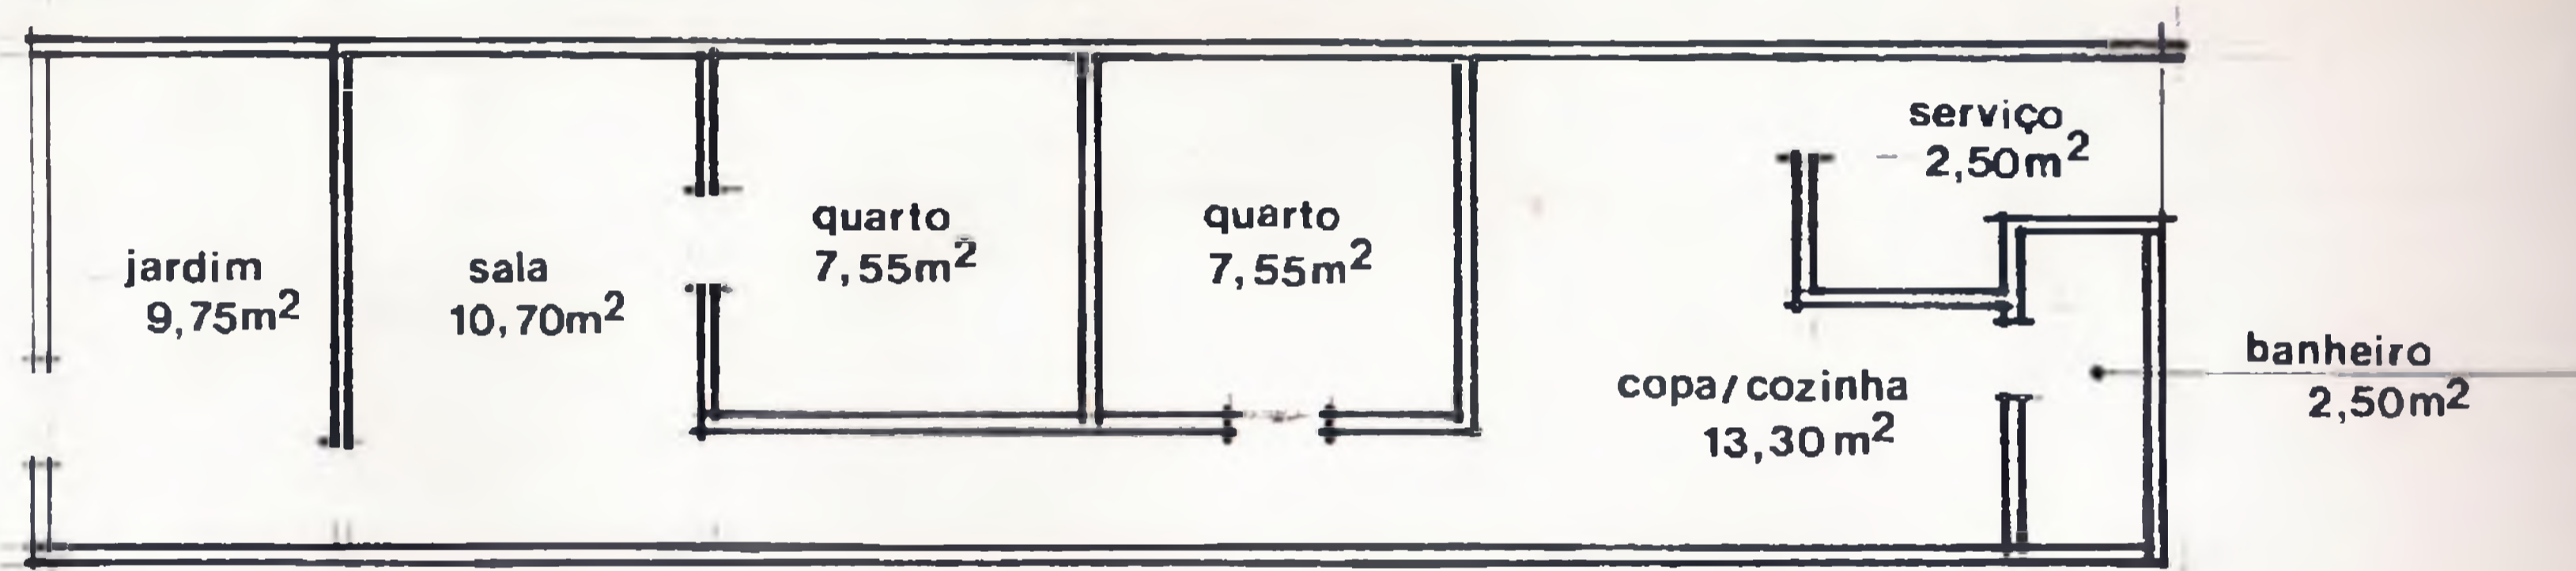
PLANTA DE RESIDÊNCIA DA FAVELA
